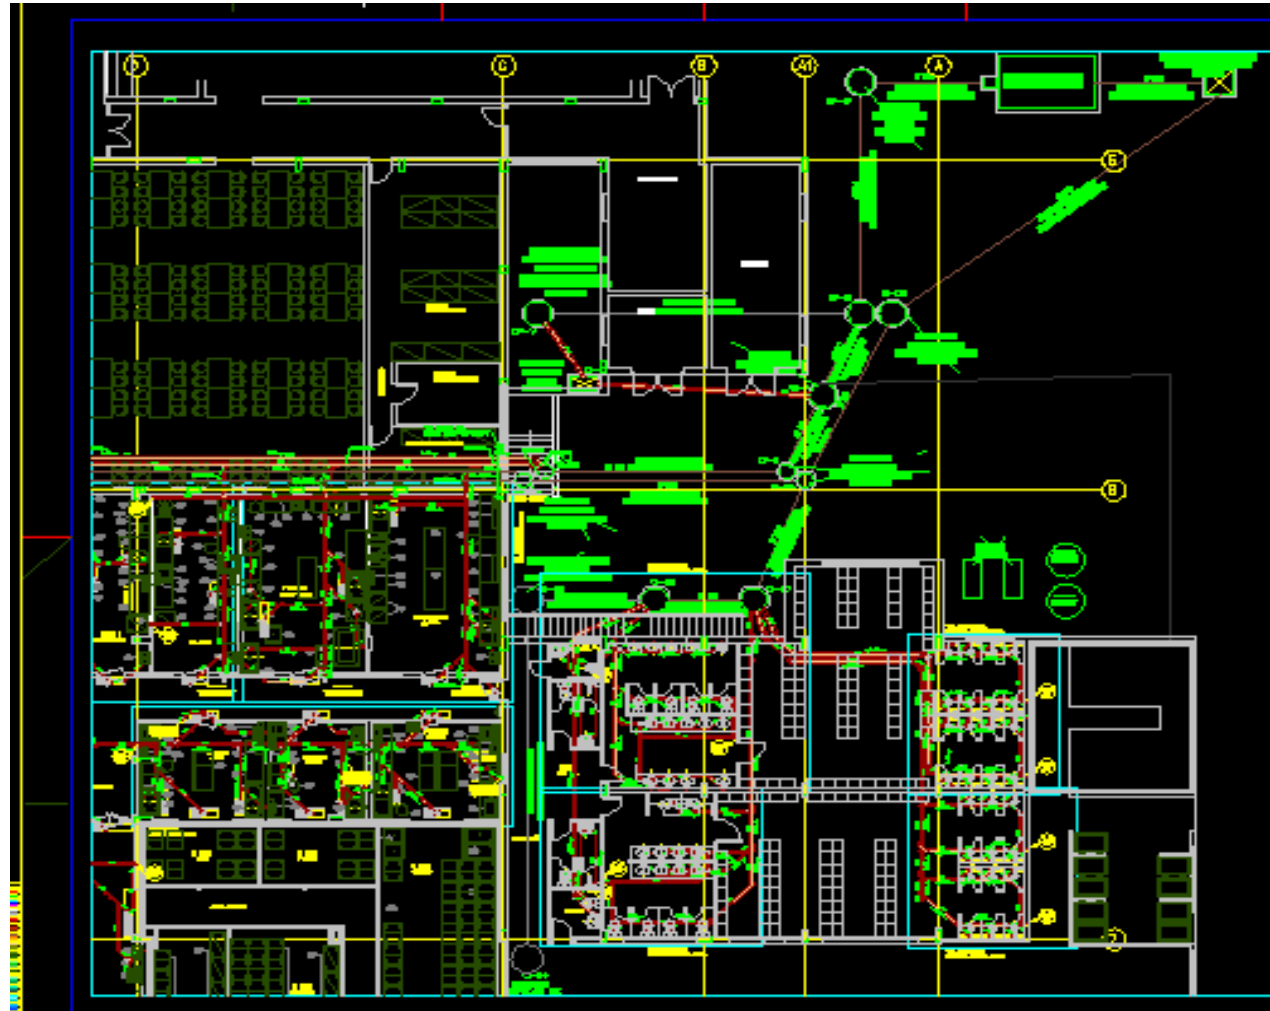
Projeto hidrossanitário – Planta 2 - Restaurante Central da VALE S.A.
